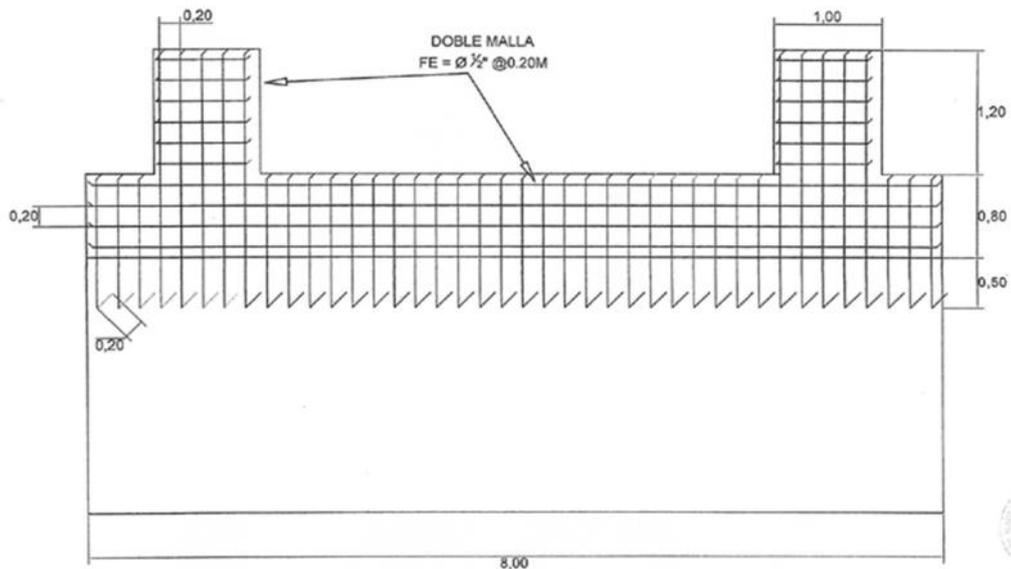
Detalle de armadura en dados de concreto para apoyo de la estructura metálica
